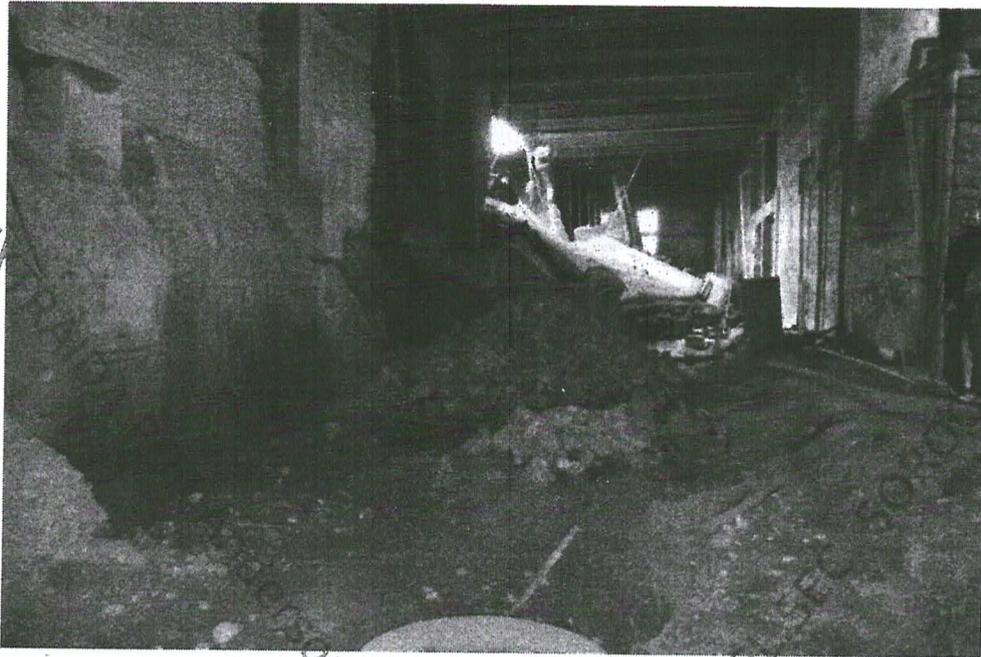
Outra vista de bloco de fundação da estrutura de contenção rompida
